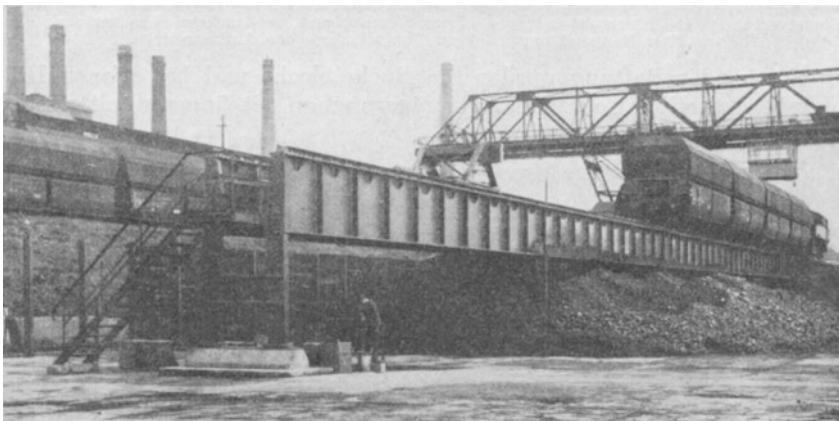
Gänzlich geschweißte Vollwandbrücke.
